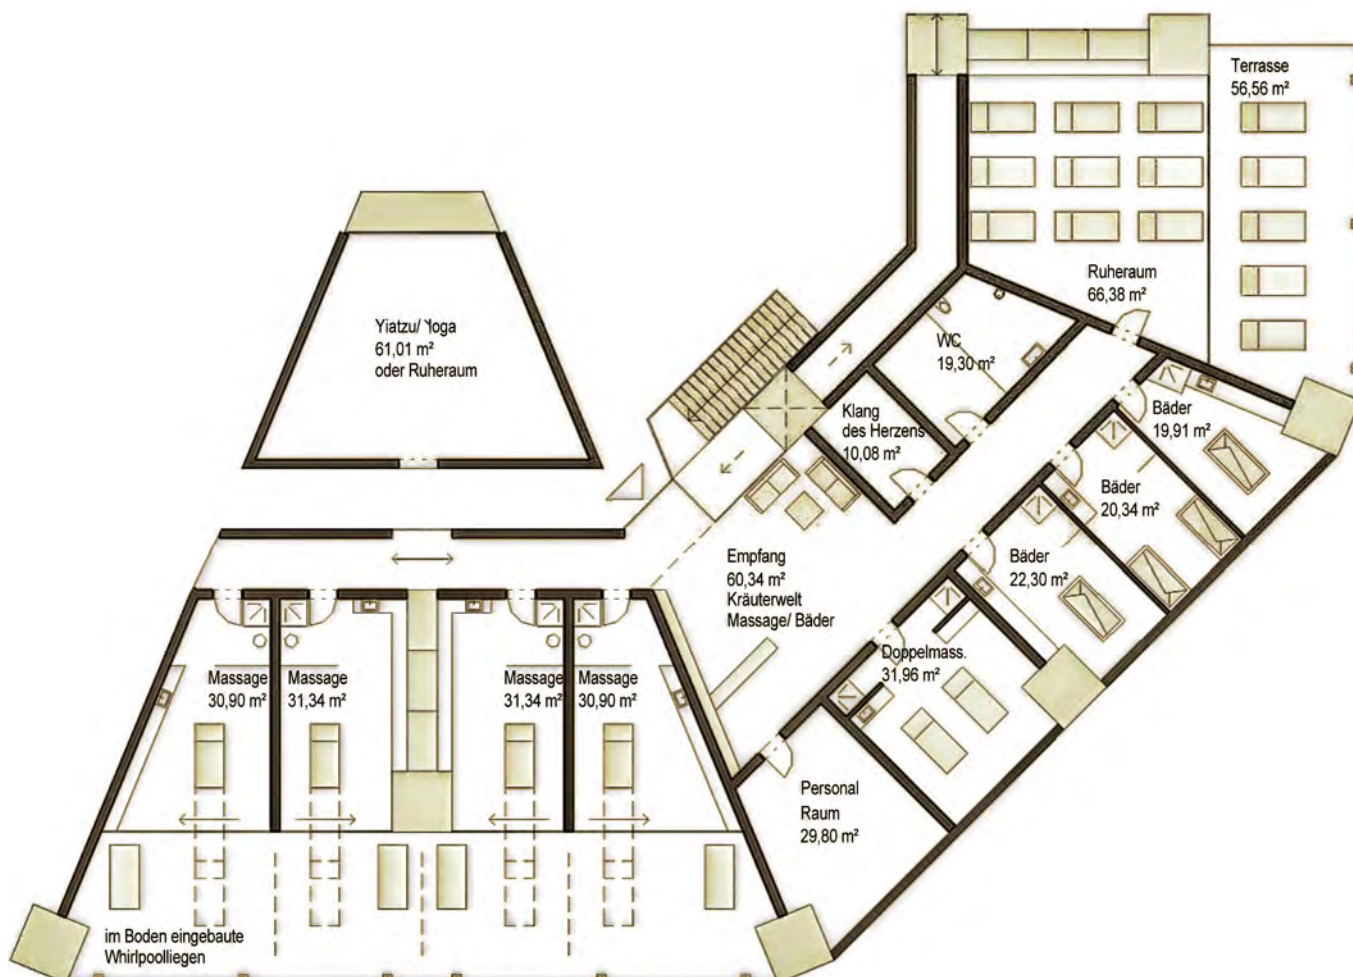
Plan Ausschnitt Massageräume und Kräuterbäder
